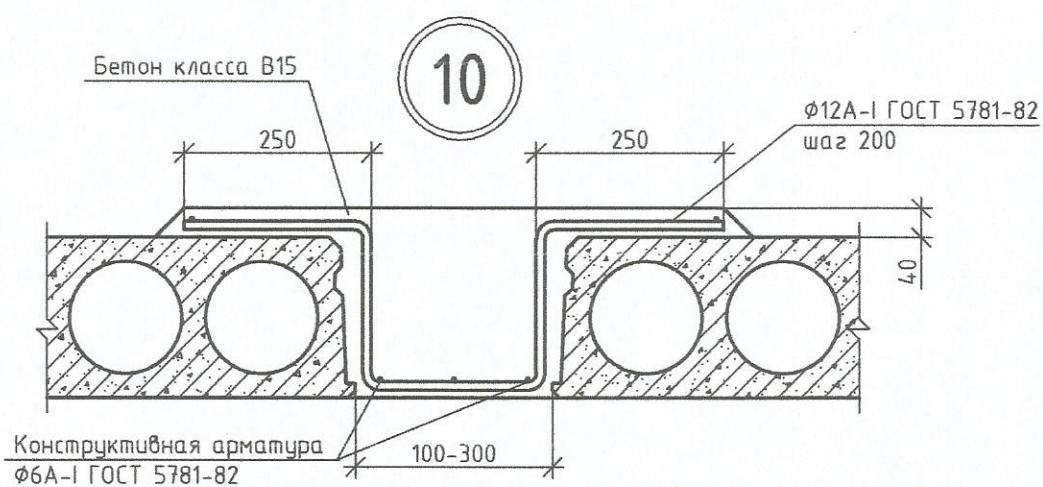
Конструкция узла 10 согласно монтажной схеме раскладки плит в перекрытиях
